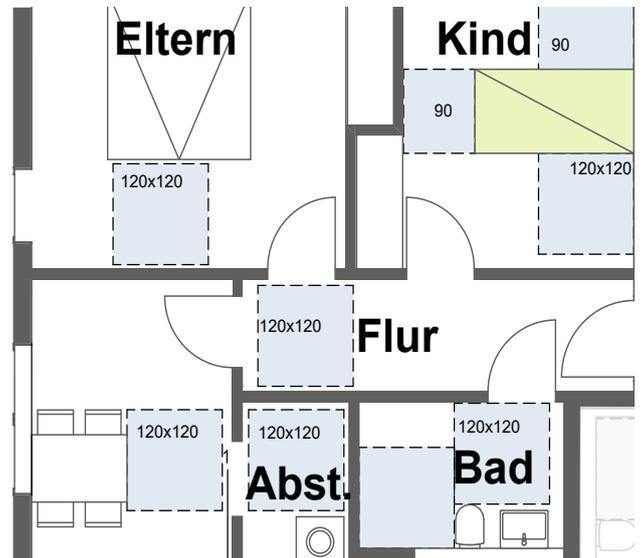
Grundriss und Bewegungsflächen
